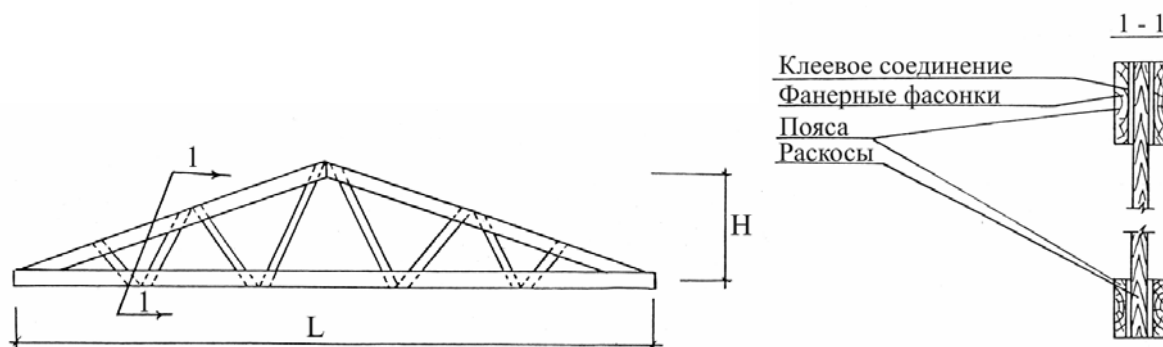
Конструкция фермы с фанерными фасонками и клеевыми соединениями в узлах
